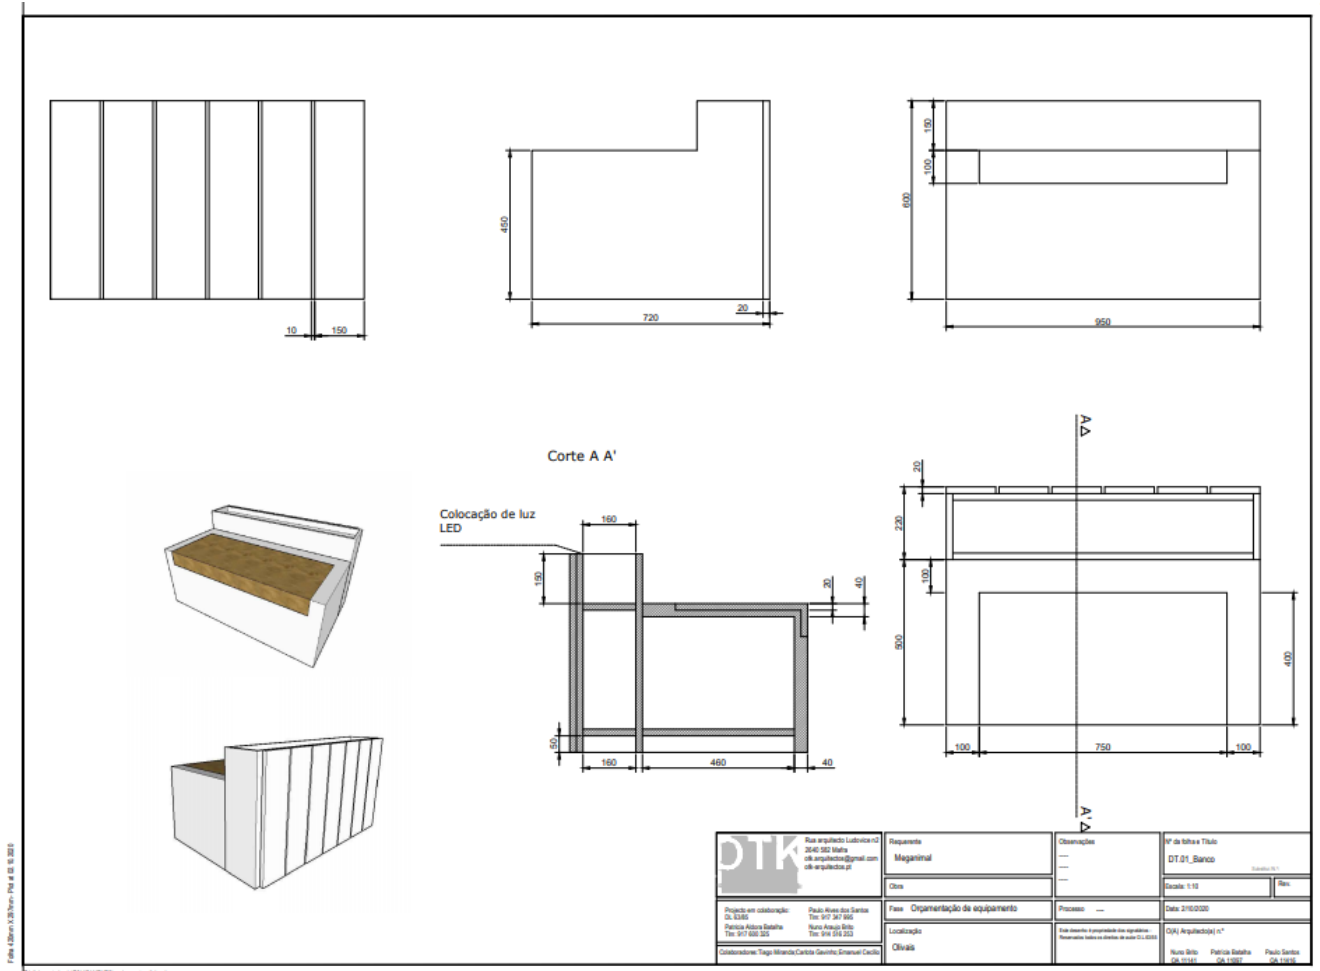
Desenho técnico de equipamento. Banco. Fonte: autor
